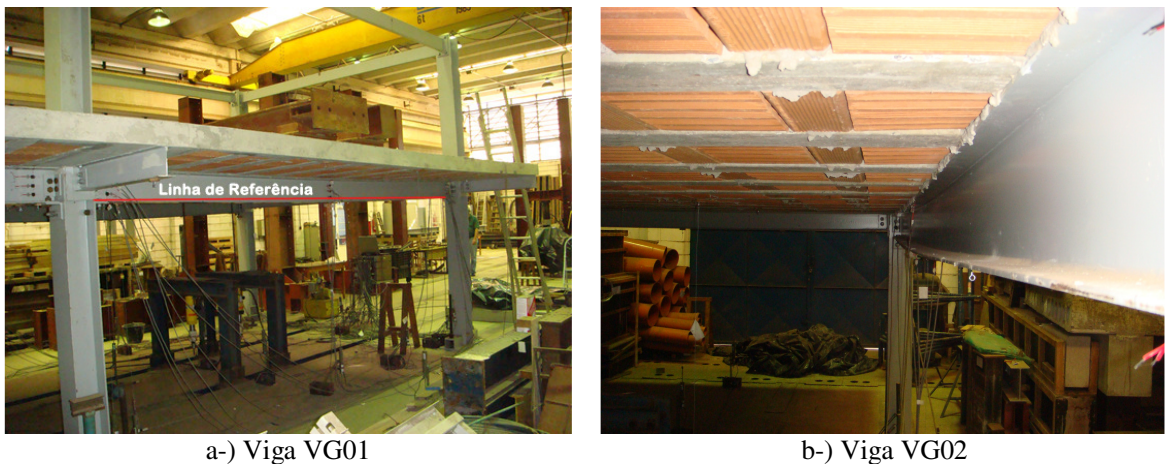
Vista da vigas principais deformadas - 8ª etapa de carregamento concentrado
